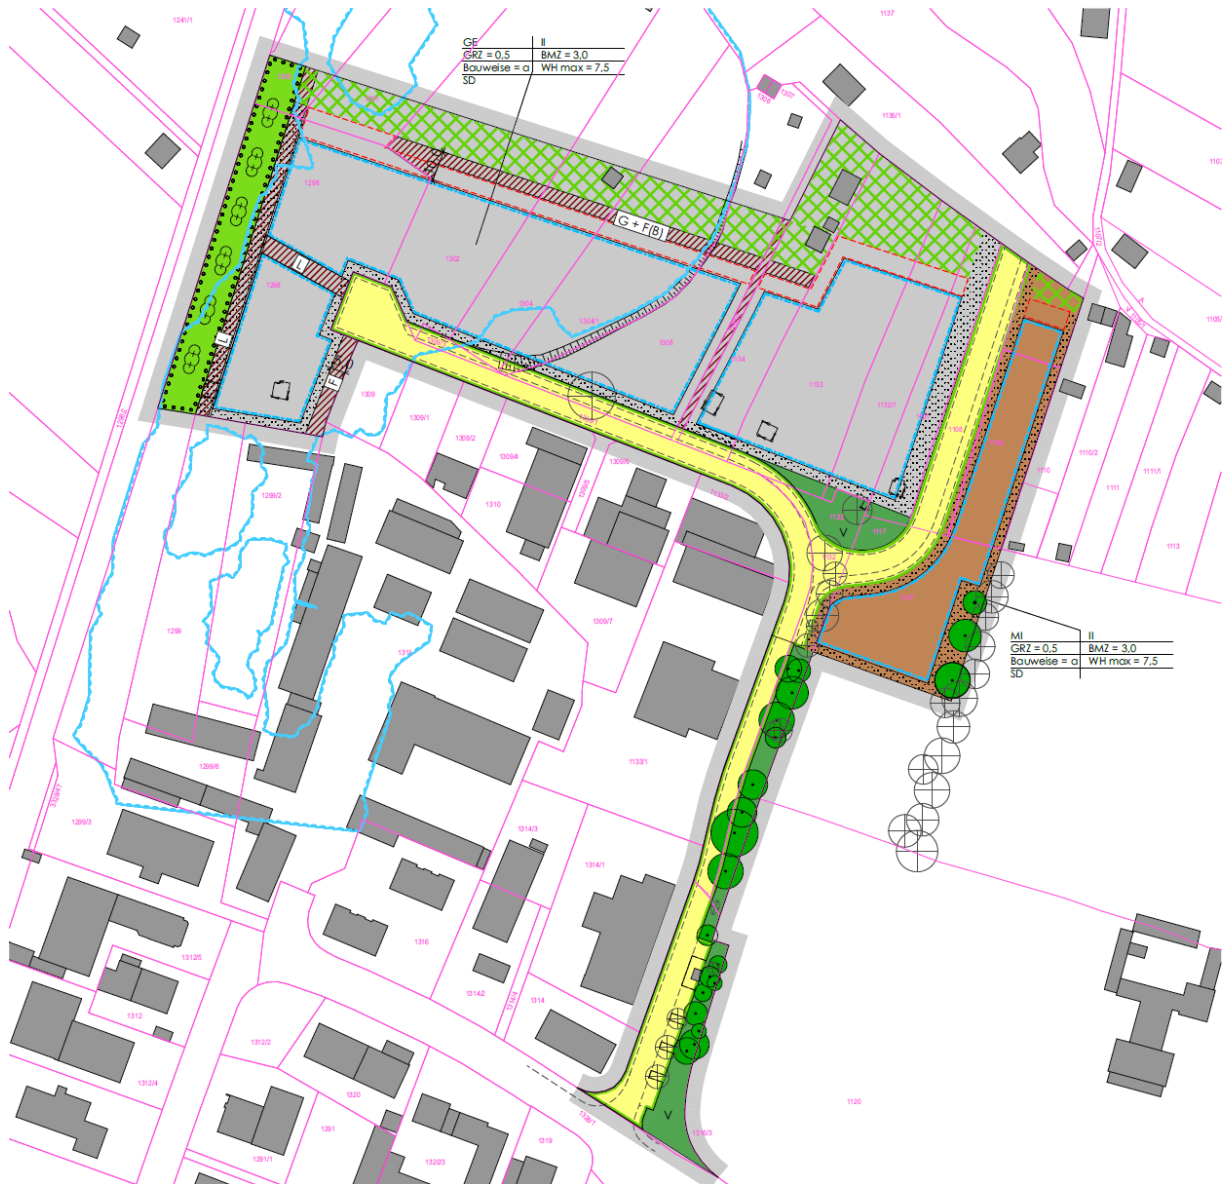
Entwurf Bebauungsplan Nr. 121 Finkenstraße Nord, DRAGOMIR STADTPLANUNG GmbH, Stand 07.07.2022
